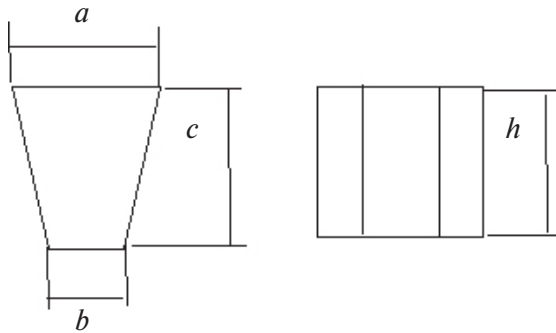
Форма и размеры изделия для кольцевой кладки:
